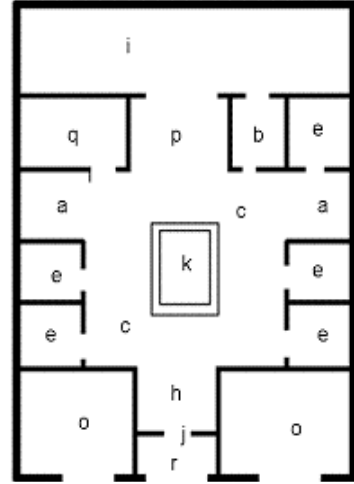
مخطط لمساكن الطبقة الغنية في العهد الروماني
